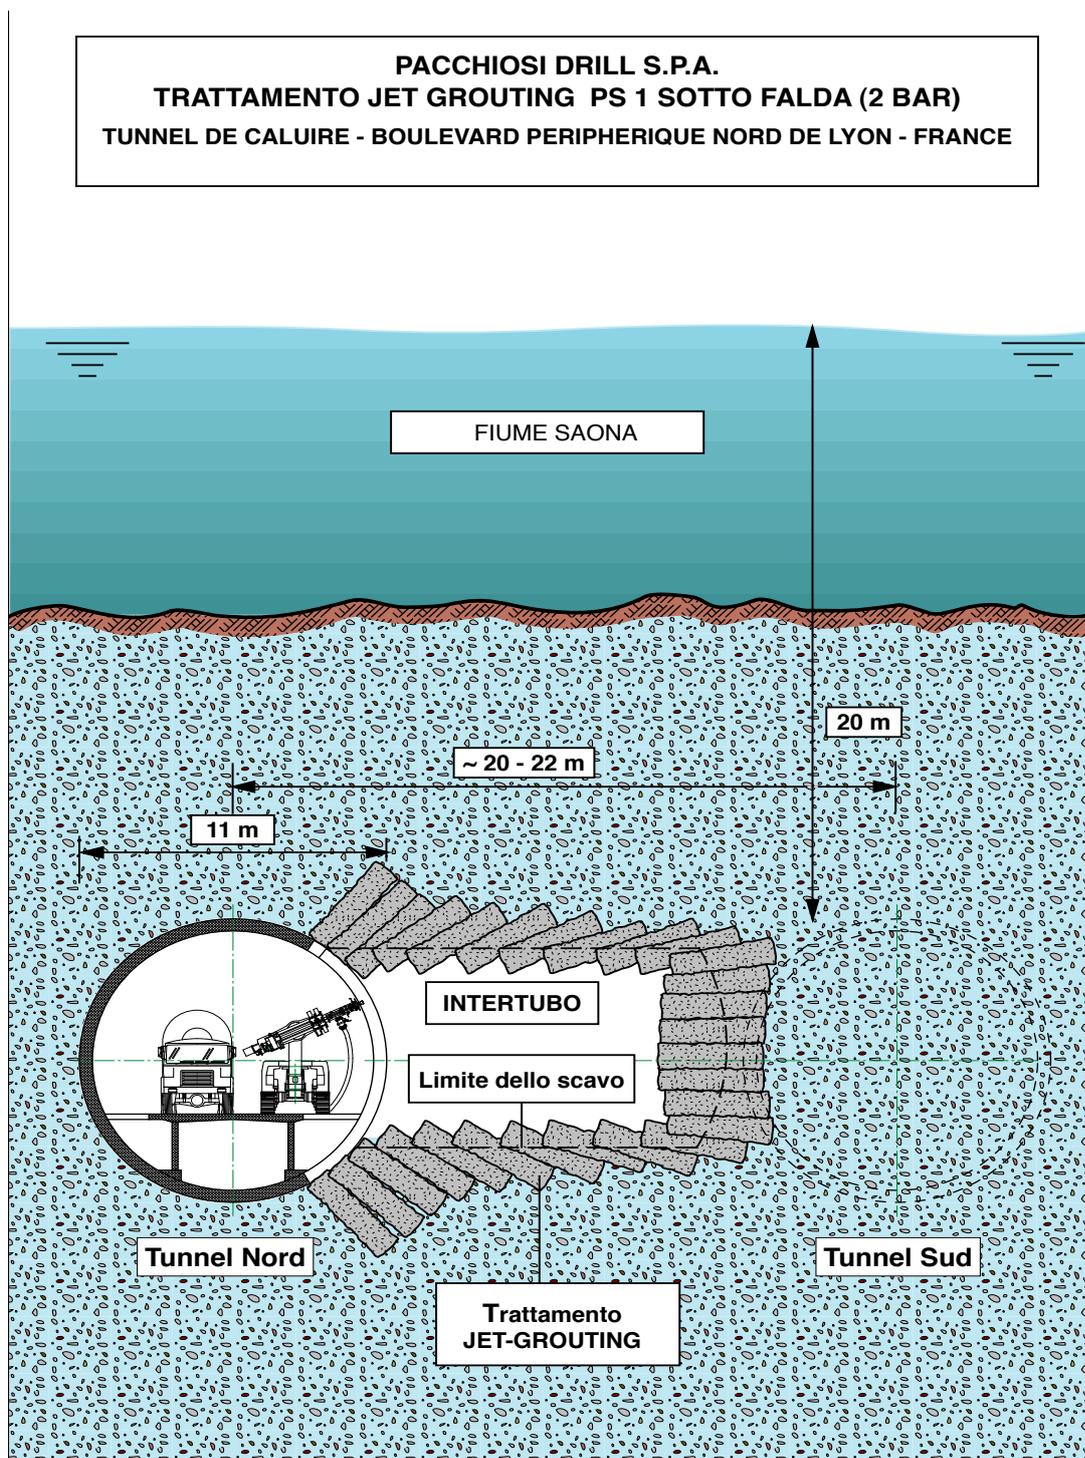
Vista schematica di assieme dell'intervento tipo.
